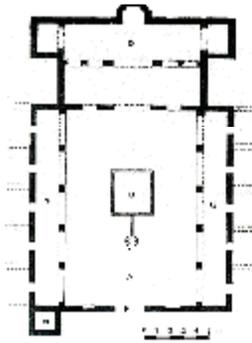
مسقط أفقي لمسجد رأس عين أزليين بفاس القديمة
